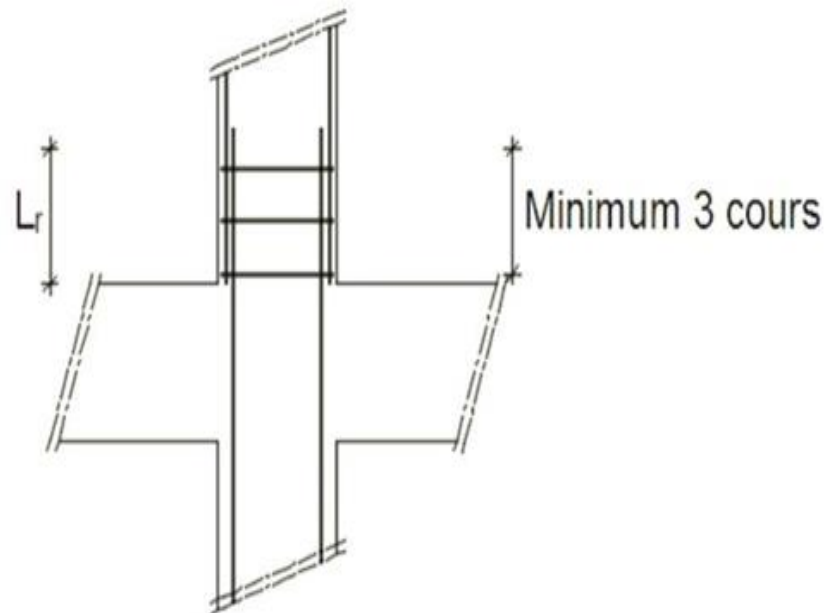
Armatures transversales dans la zone de recouvrement
